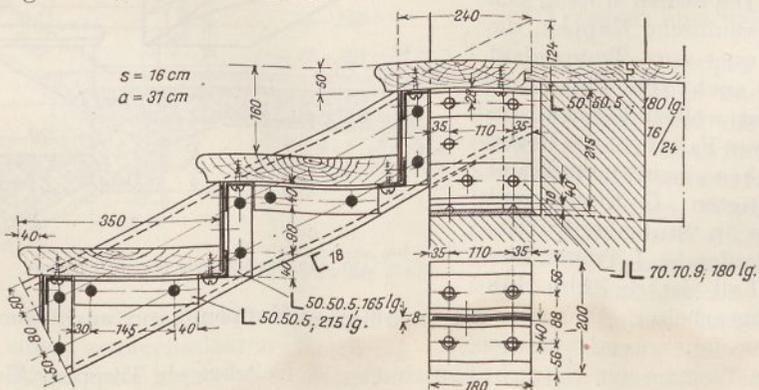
Stahl-Treppe mit hölzernen Trittstufen.
